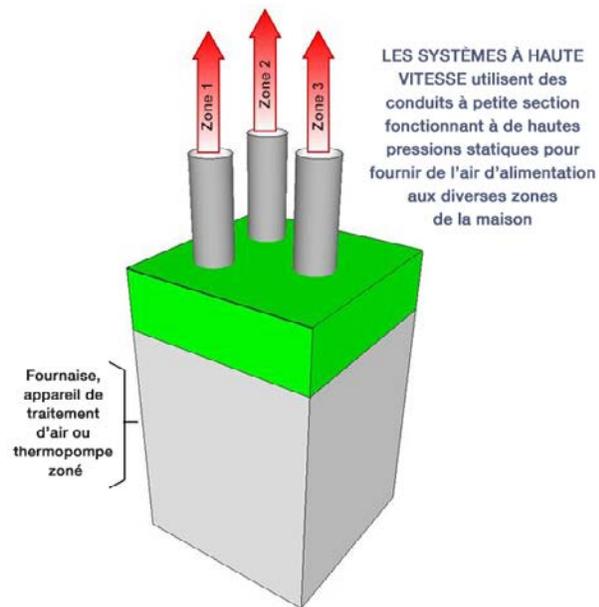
Système de conduits à haute vitesse d'écoulement de l'air
